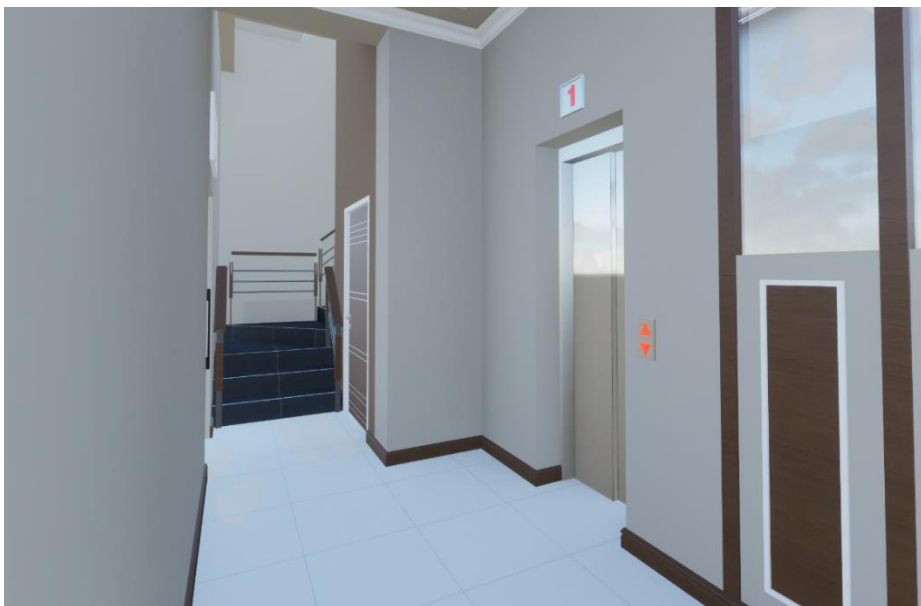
Circulación vertical y horizontal. Escalera secundaria y caja de montacarga.
